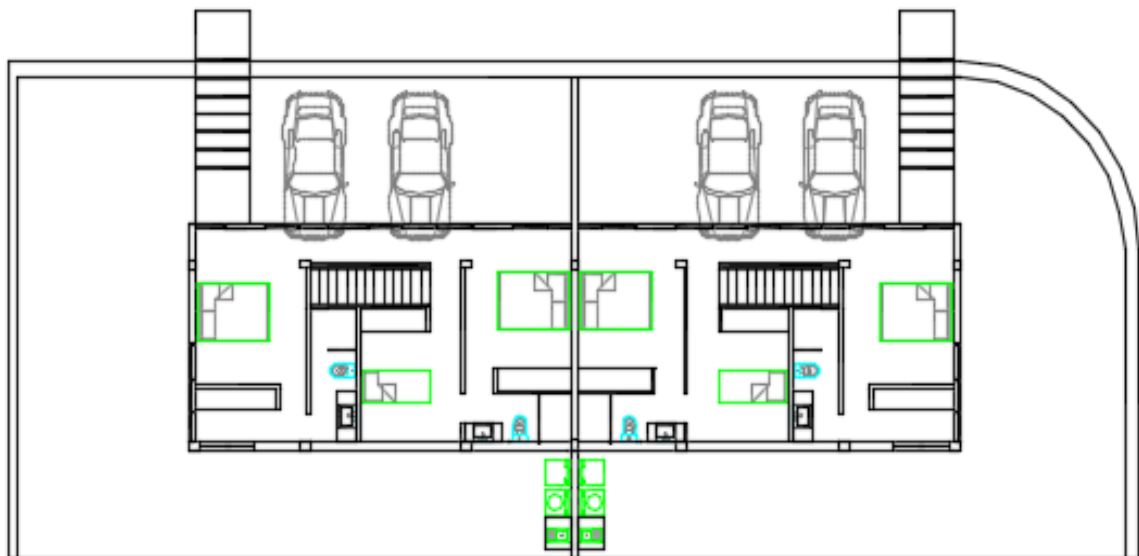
implantación del proyecto Ukumary 2da planta – Fuente: Carphio (2017)
